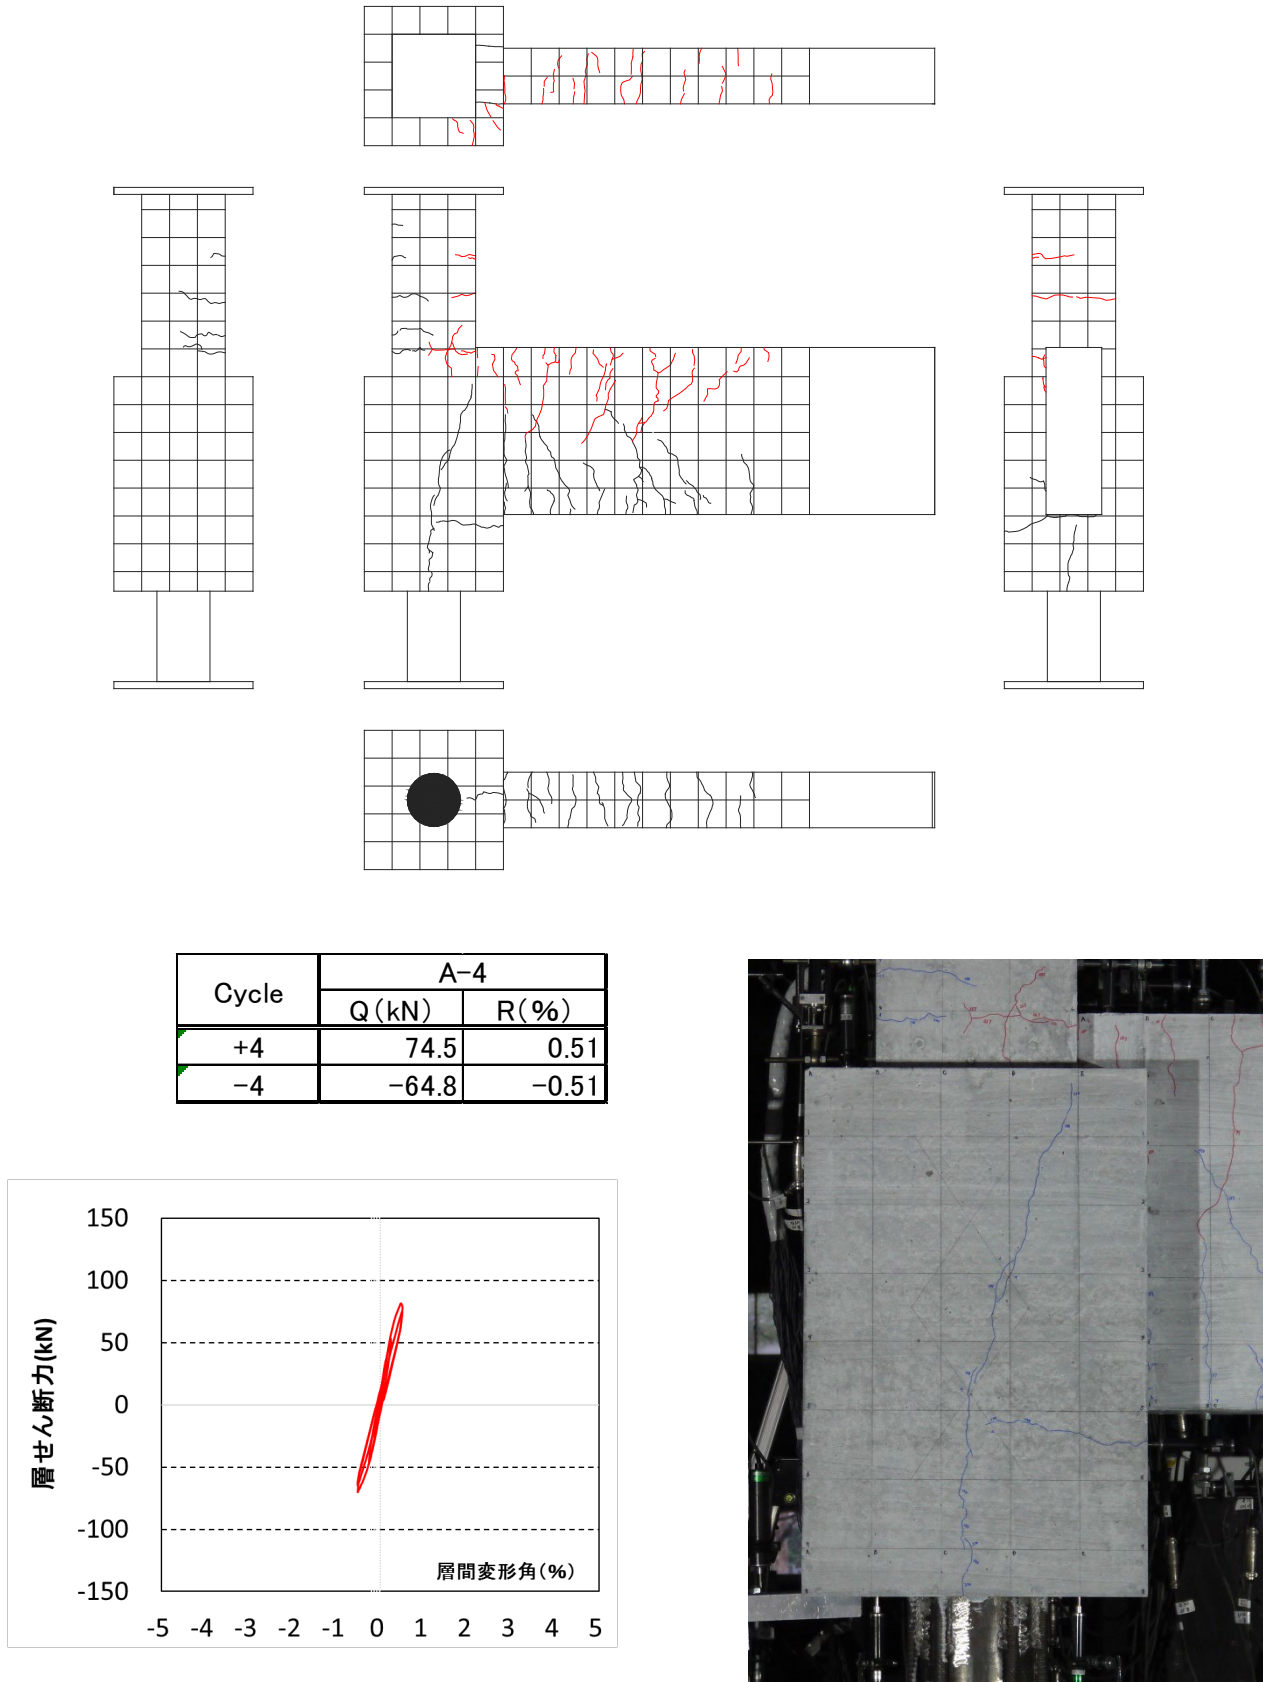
試験体 A-4 ひび割れ状況 (2Cycle)
